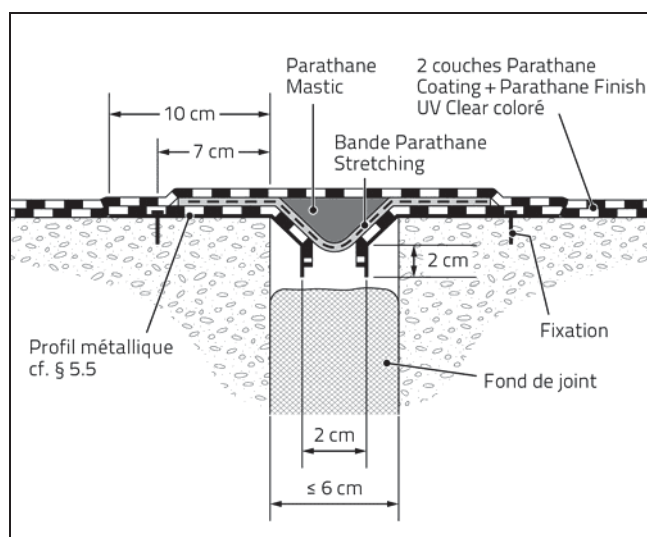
Joint de dilatation pour terrasse accessible hors dalle sur plots
